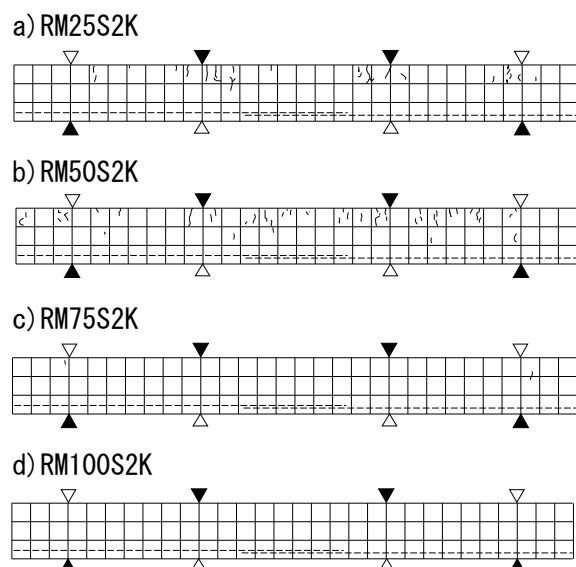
乾燥収縮ひび割れ発生状況(材齢2年)
